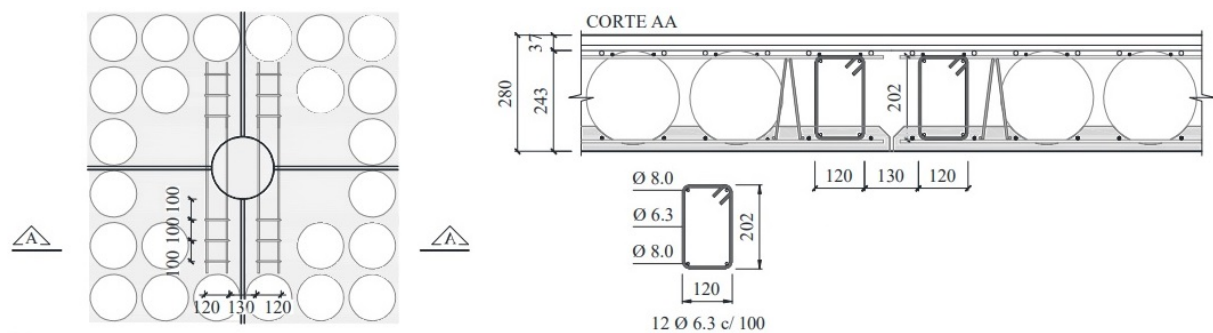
Armadura de cisalhamento da laje BD28-P3 (dimensões em mm) (fonte: Nicácio (2018))
